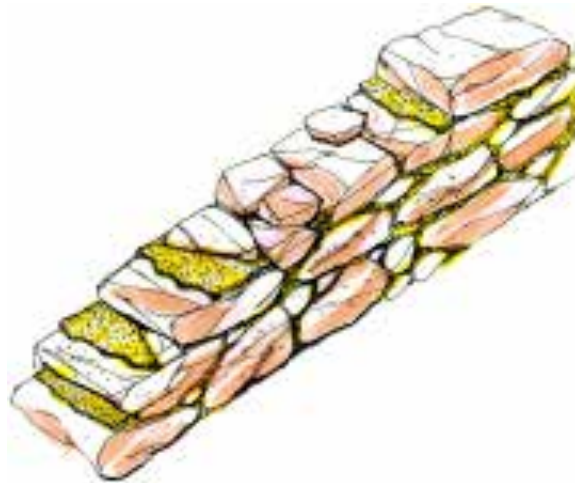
Parede em alvenaria de pedra aparente irregular. (Ilustração nossa, 2020).
